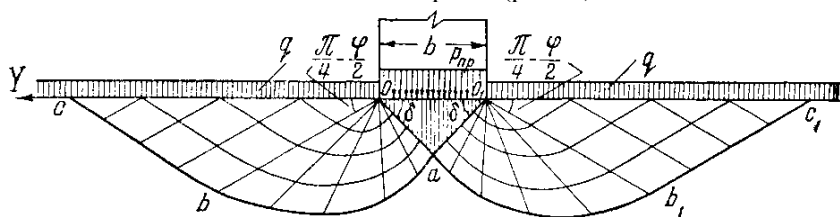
Расчетная схема сдвига грунта в теории предельного напряженного состояния грунта
